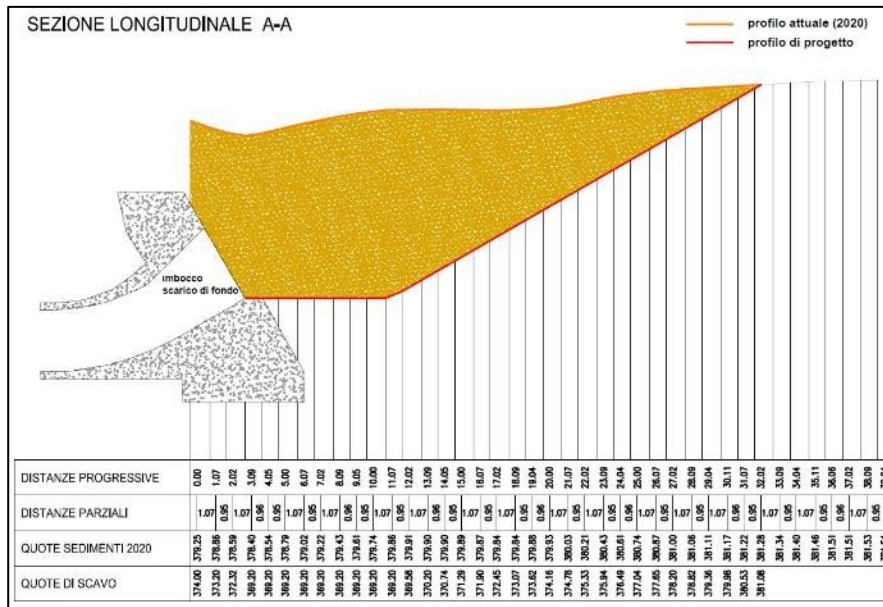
Sezioni longitudinali rispetto all'imbocco di scarico delle quote attuali dei fondali (2020) e di quelle finali al termine dei lavori di dragaggio
